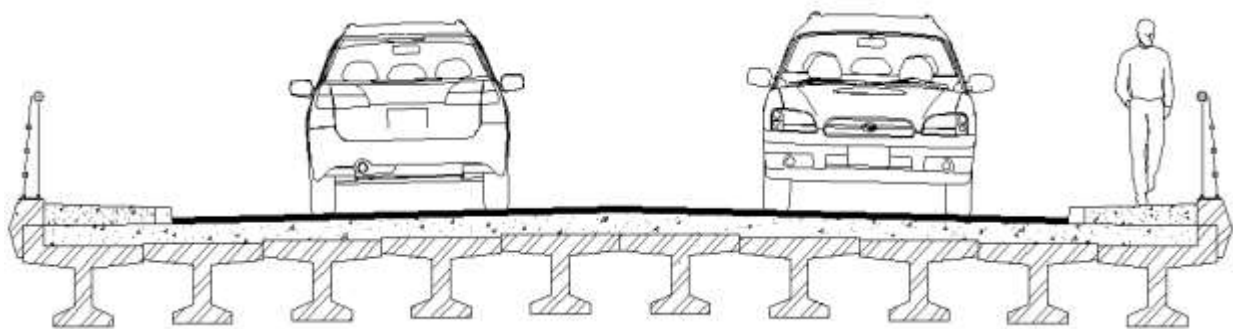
Secção transversal com vigas “T” do tabuleiro de uma ponte
